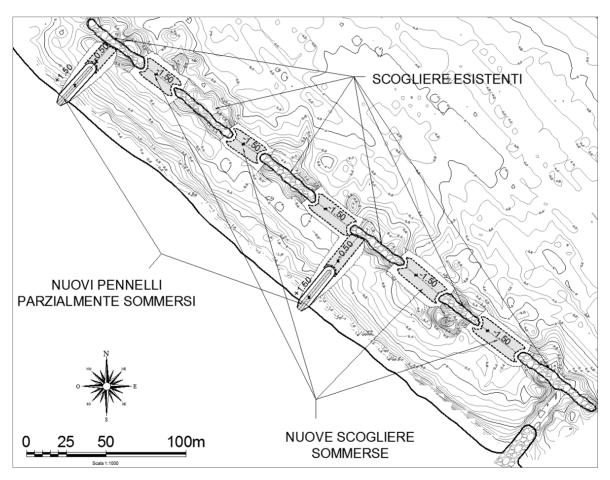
Planimetria di progetto delle opere di difesa in località Valle delle Grotte.
